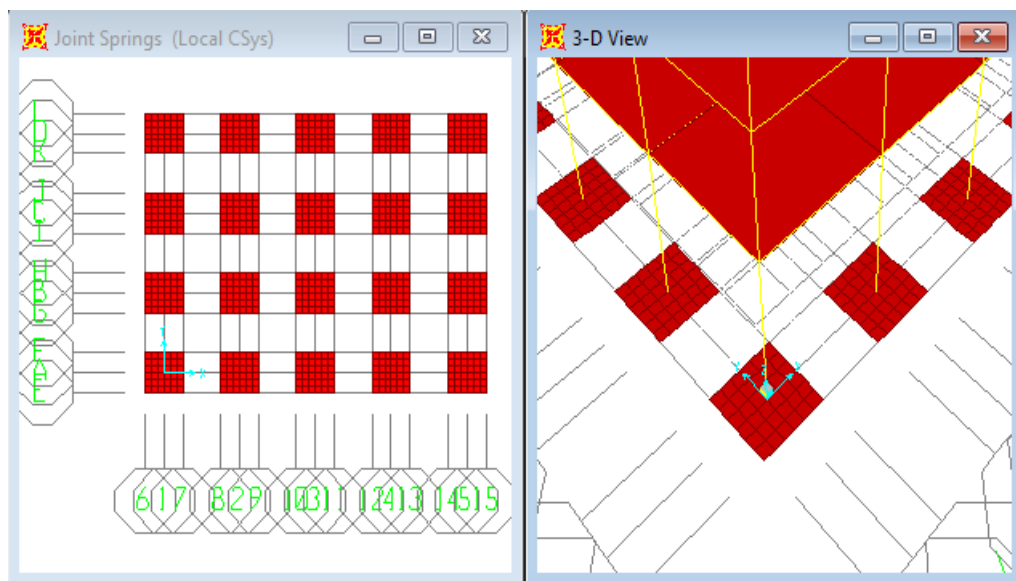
Maillage des semelles isolée pour (R+3).
